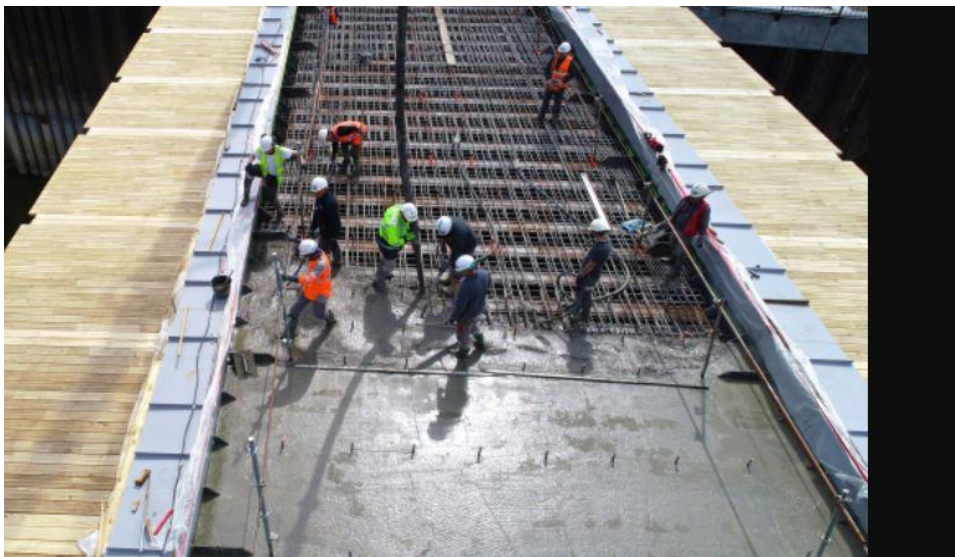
Le béton coulé sur le tablier du pont des ARTS-ET-MÉTIERS.[25]
